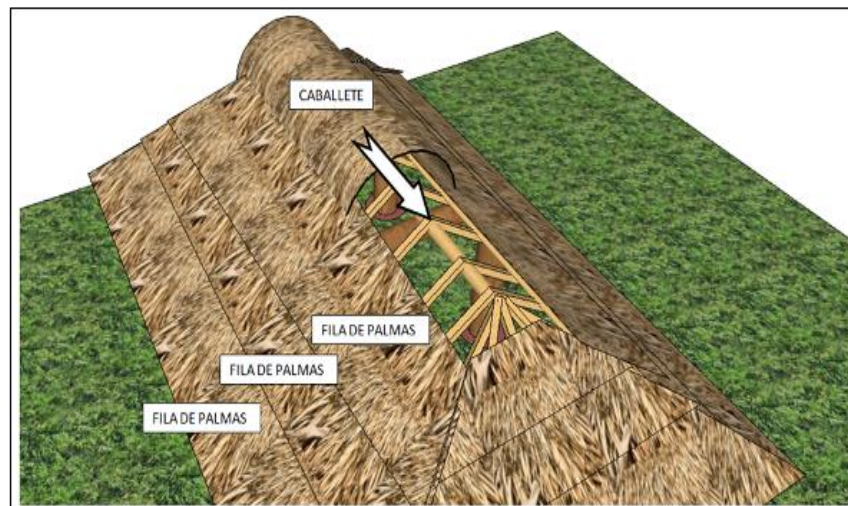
Caballete de la cubierta. Fuente: Cuartas (2013).
